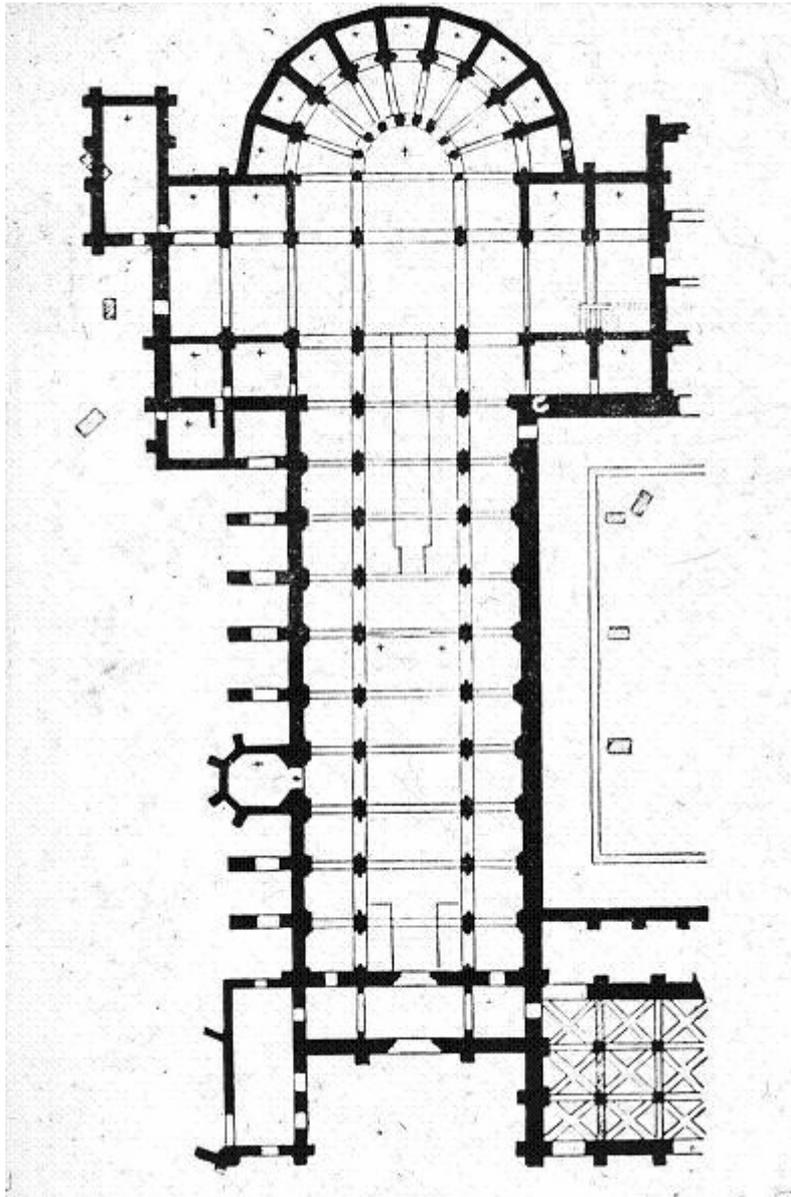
Ville-sous-la-Ferté, Abteikirche Clairvaux III (1154 - 1174), Grundriss
